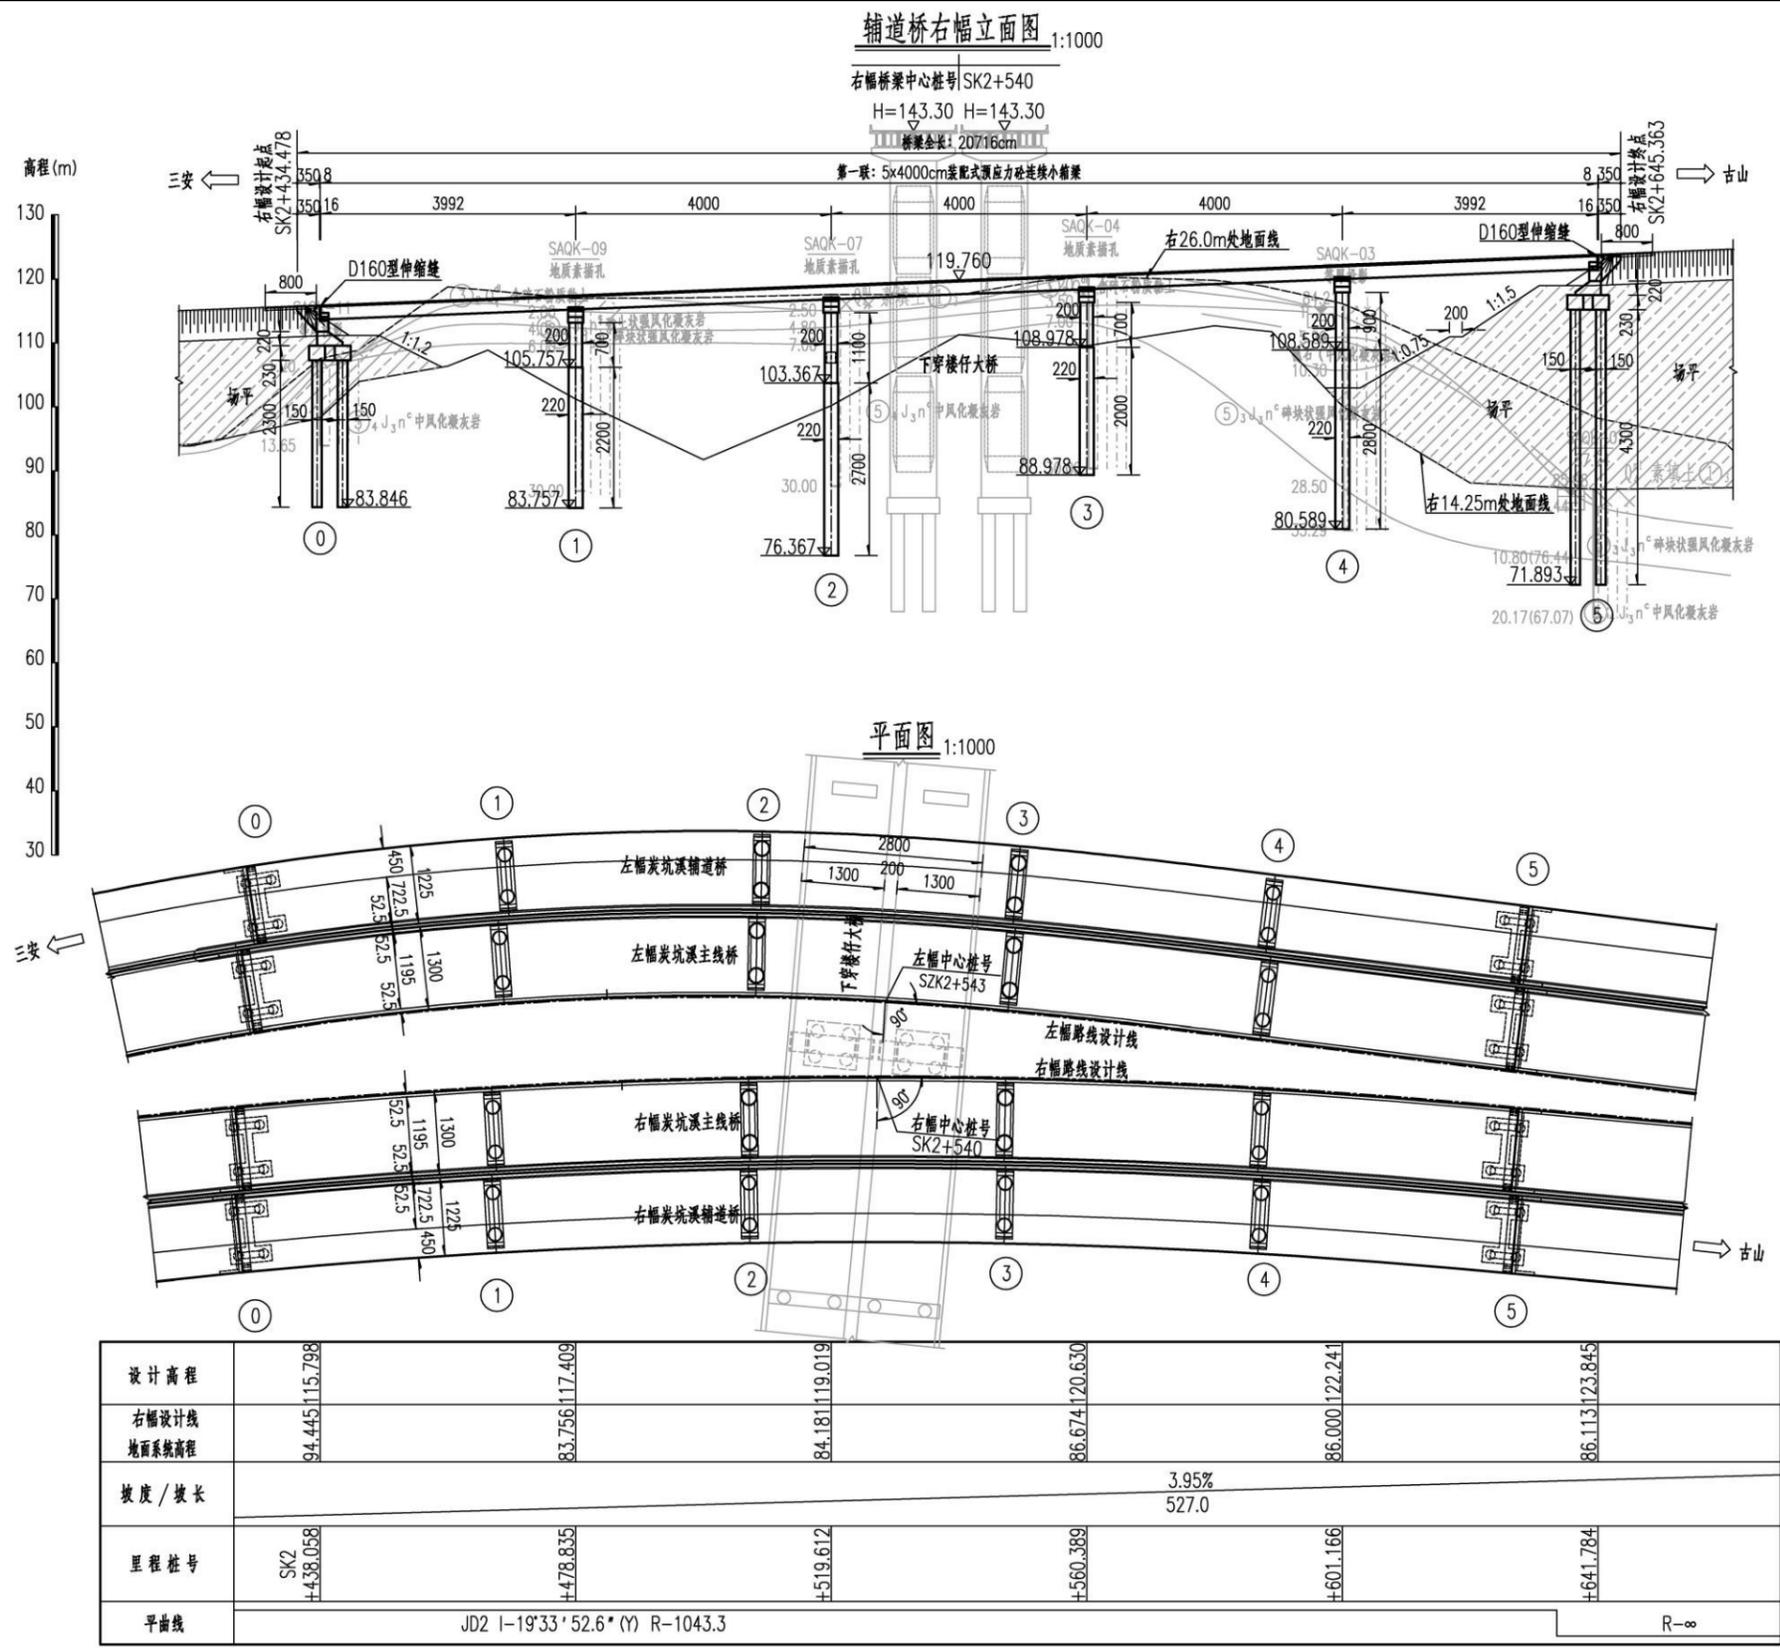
本项目炭坑溪大桥辅道桥右幅立面图
